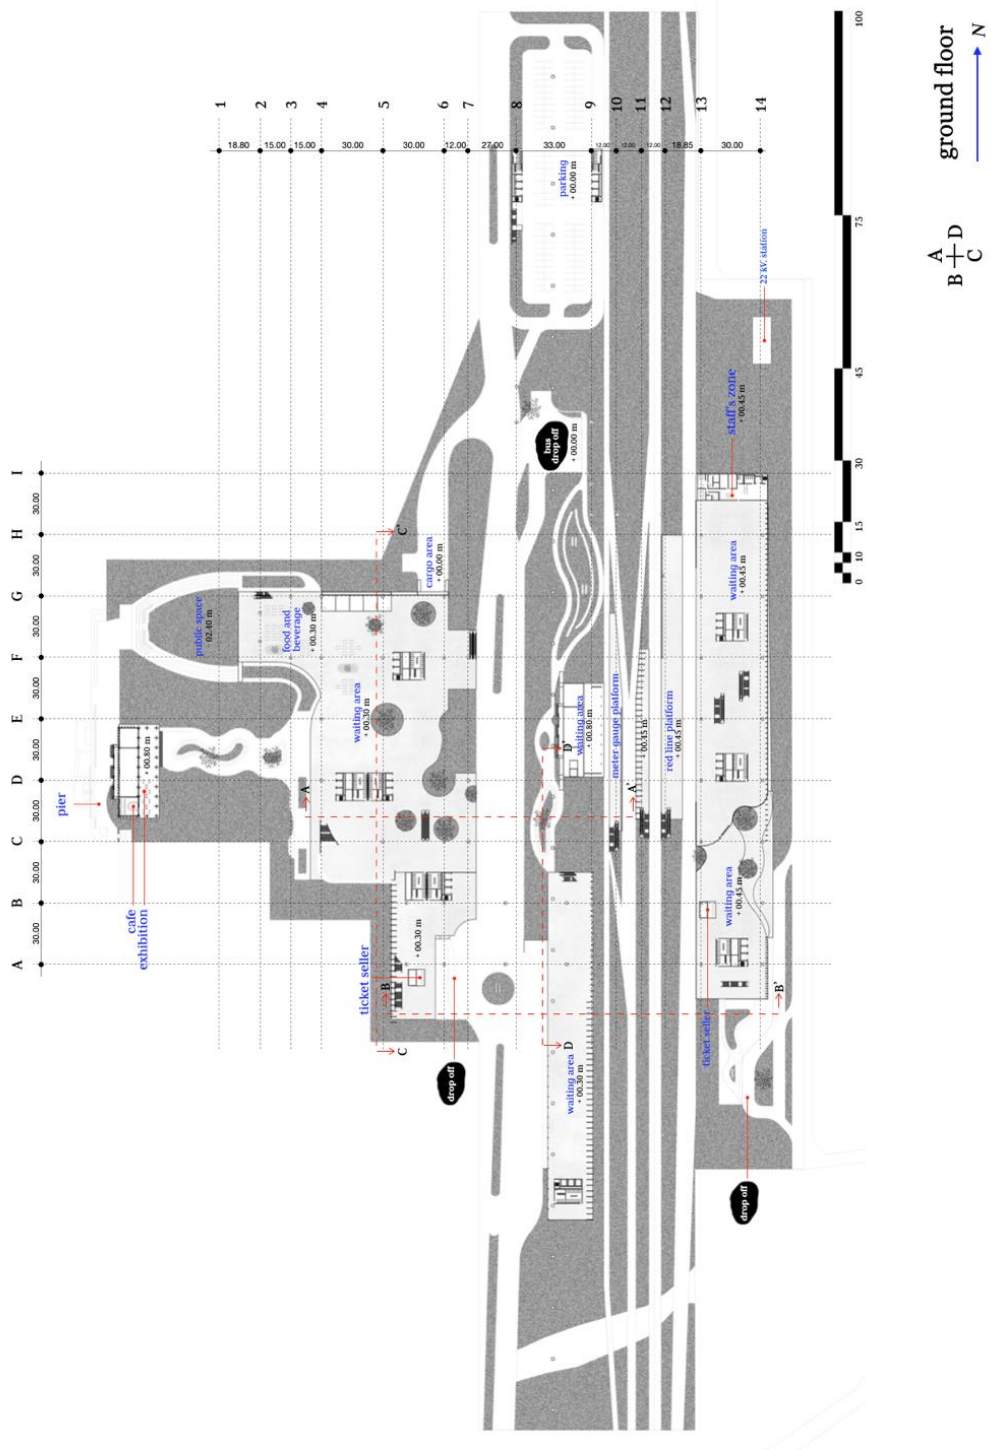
สถานีรถไฟในการออกแบบครั้งสุดท้าย Layout plan
